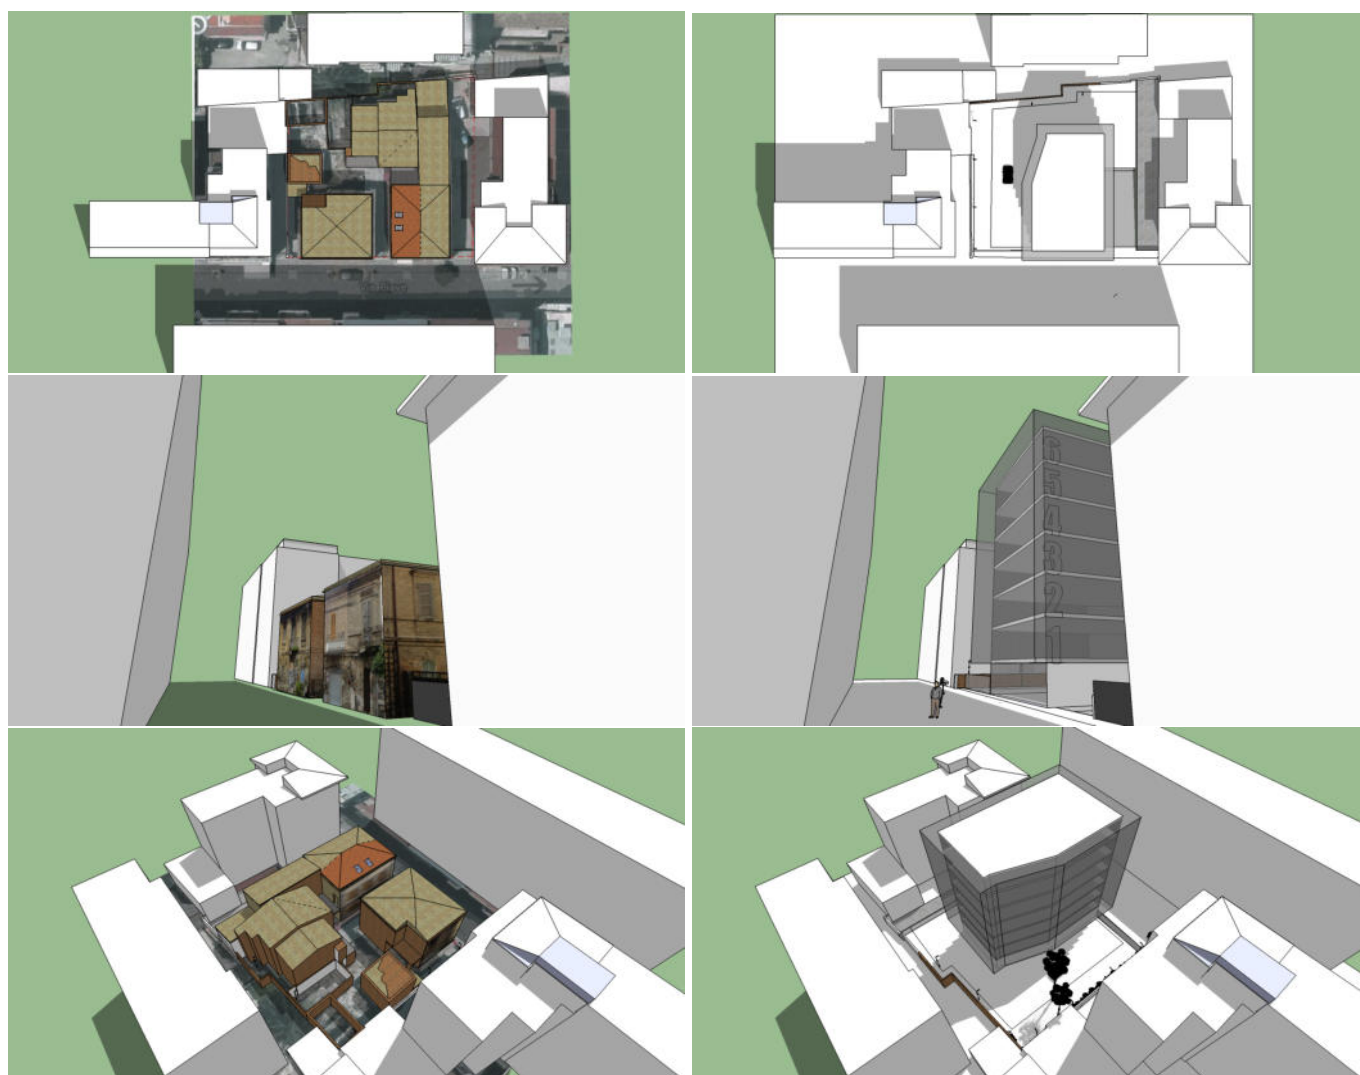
simulazioni plano-volumetriche e tridimensionali di confronto tra stato di fatto e progetto
